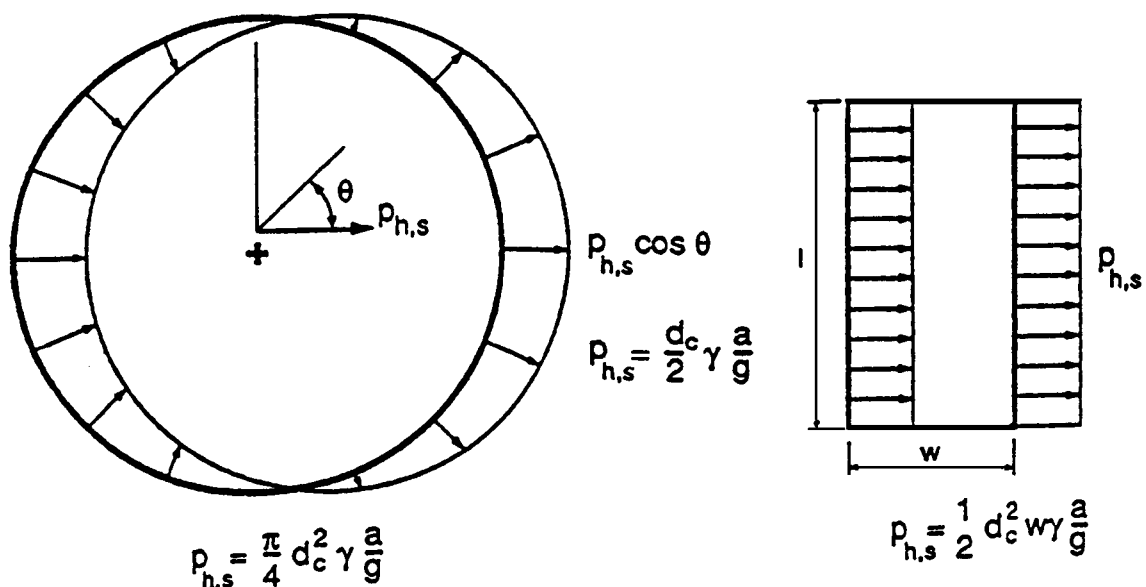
Vista en planta de la presión horizontal adicional debida a acciones sísmicas sobre la zona de paredes verticales de silos de sección circular y rectangular
